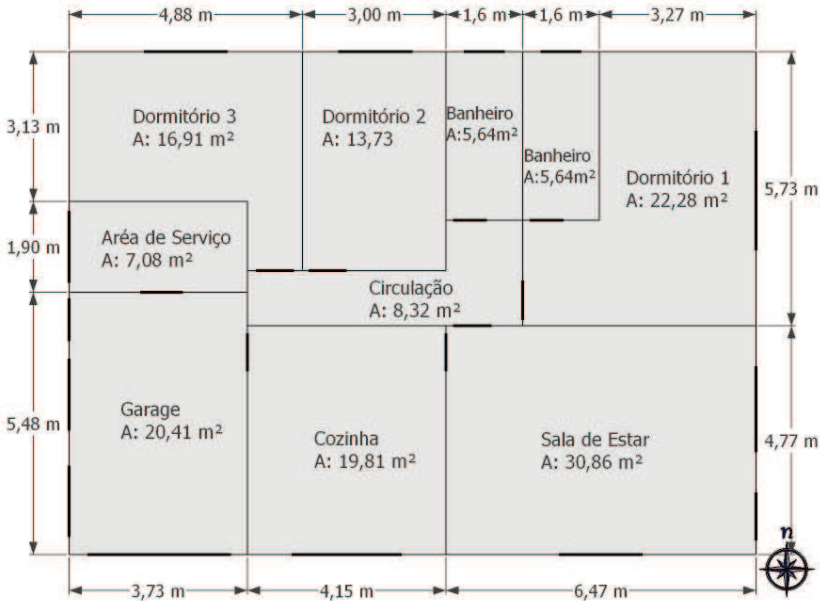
Croqui da planta baixa do modelo unifamiliar 2
